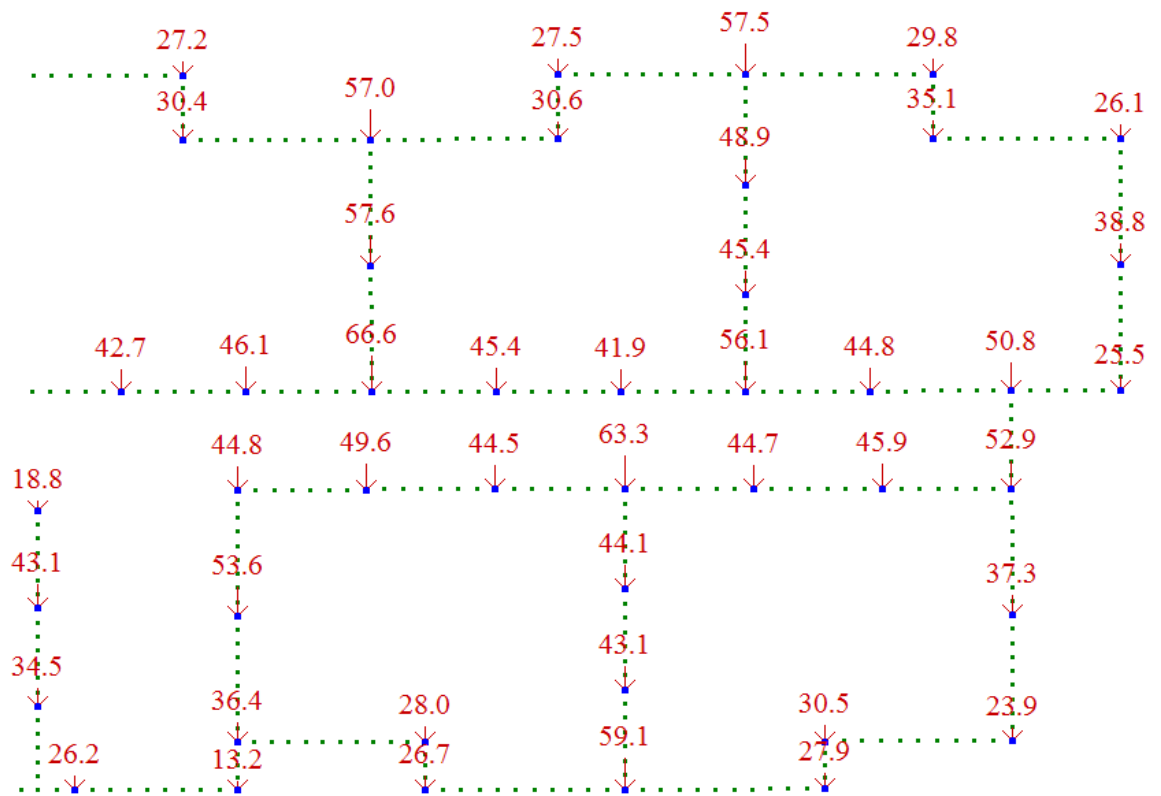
Вертикальная нагрузка в тоннах на сваи в осях 8-14 (шаг узлов – 28см).
